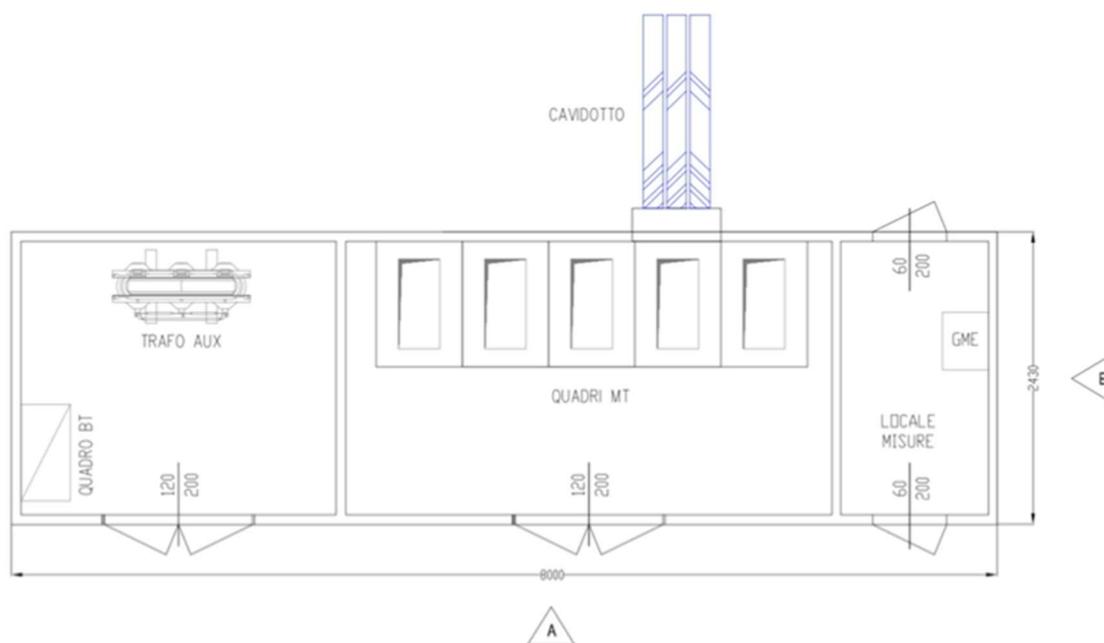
Locale cabina di Parallelo MT-Prospetto
